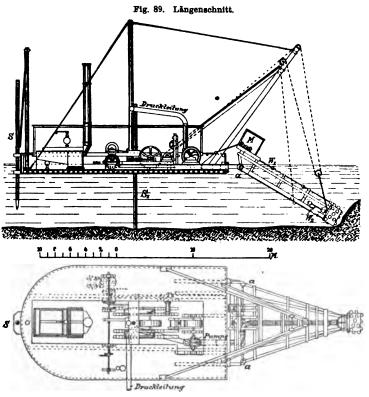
Grundriss. Centrifugalpumpen-Bagger.
